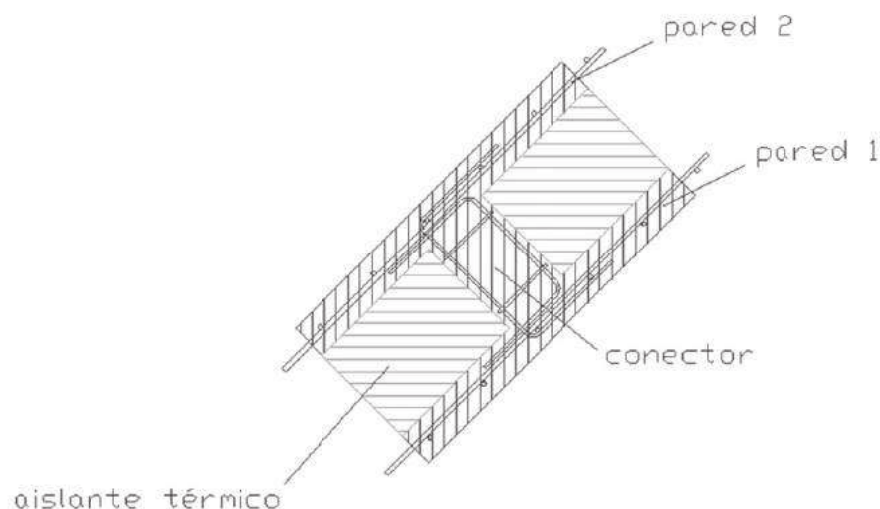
Elemento estructural de doble pared de hormigón armado (Elaboración propia)
